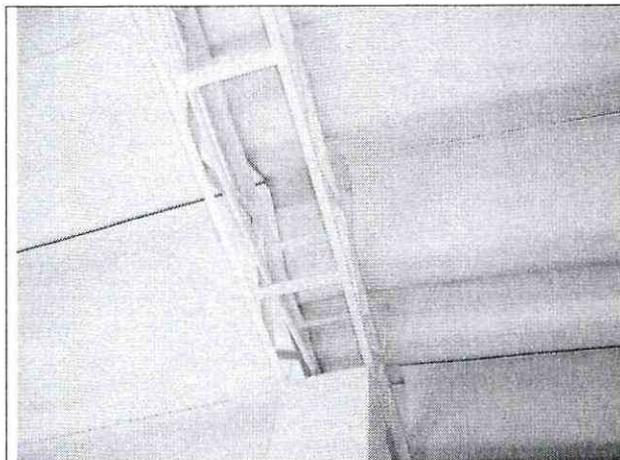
Apoyo de las tejas de cubierta sobre la viga en celosía de la cumbra. Nótese el apoyo extremadamente reducido de las tejas de la derecha.
